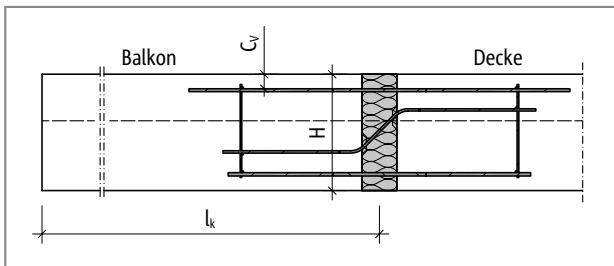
Schöck Isokorb® Typ SXT: Statisches System
